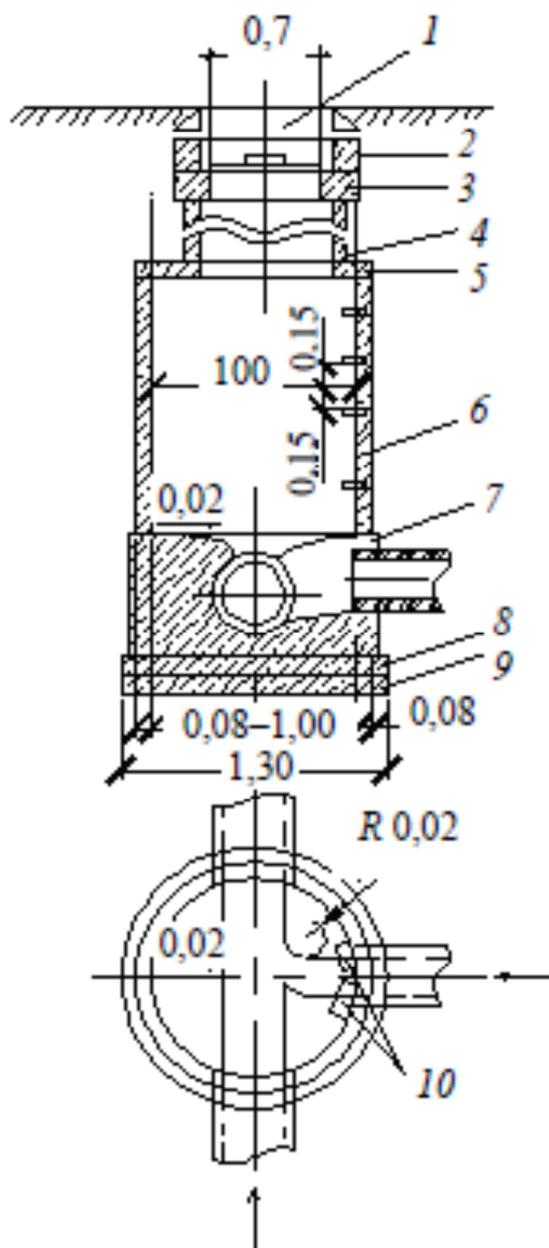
Узловой колодец диаметром до 400 мм: 1 – чугунный люк с крышкой, 2,3 – кольца регулировочное и опорное, 4,6 – железобетонные кольца диаметром 700 и 1000 мм, 5 – плита перекрытия, 7 – регулировочные блоки, 8 – основание, 9 – подготовка, 10 – скобы
